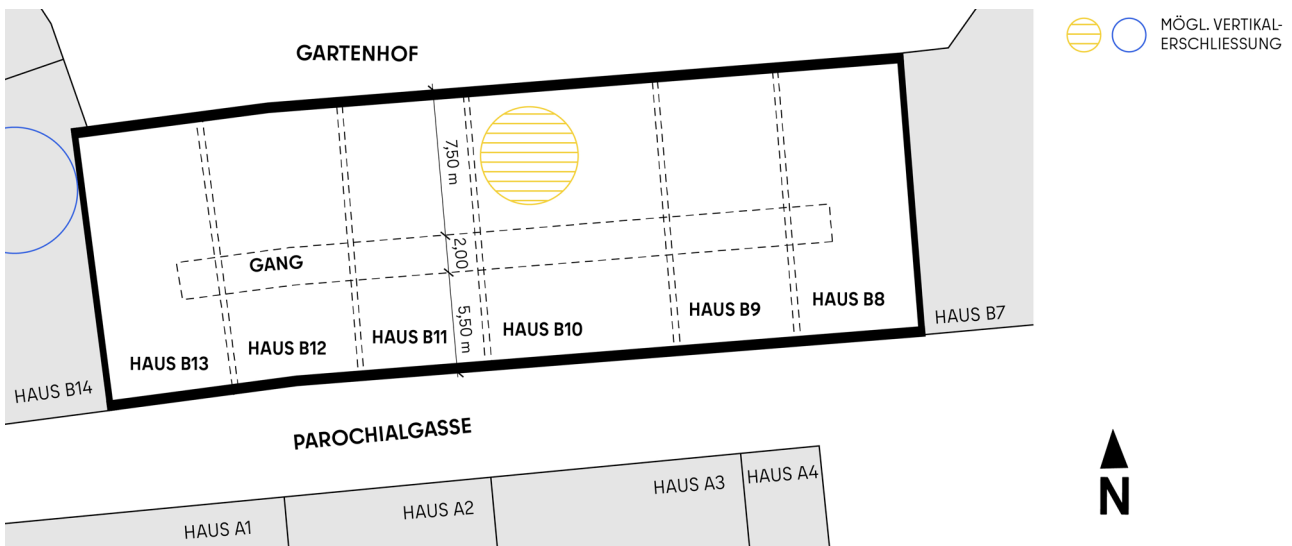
Schematischer Grundriss Untergeschoss
